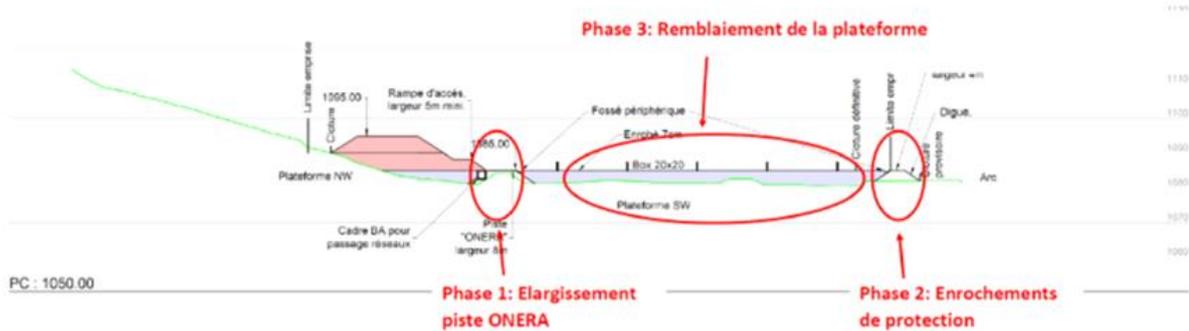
Coupe longitudinale du site du Moulin des travaux préparatoires
